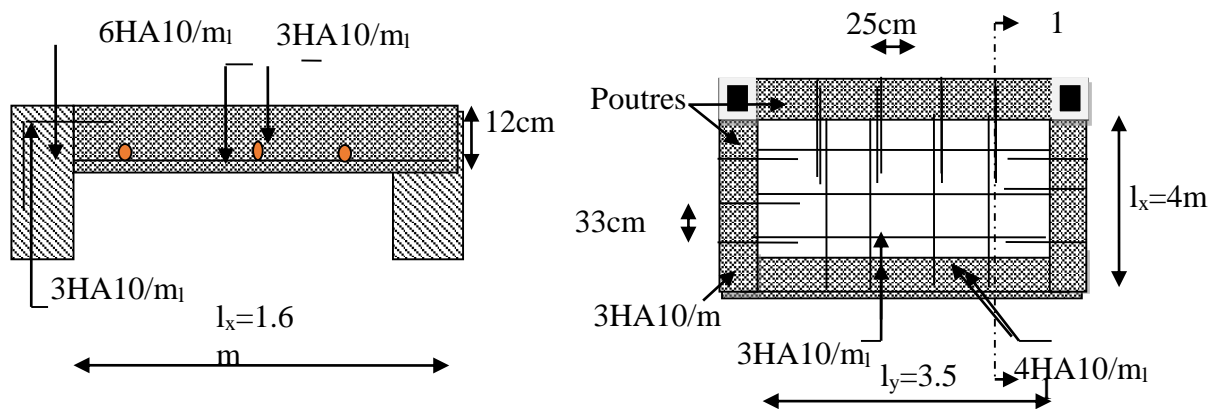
Schéma de ferrailage des dalles RDC et D3
